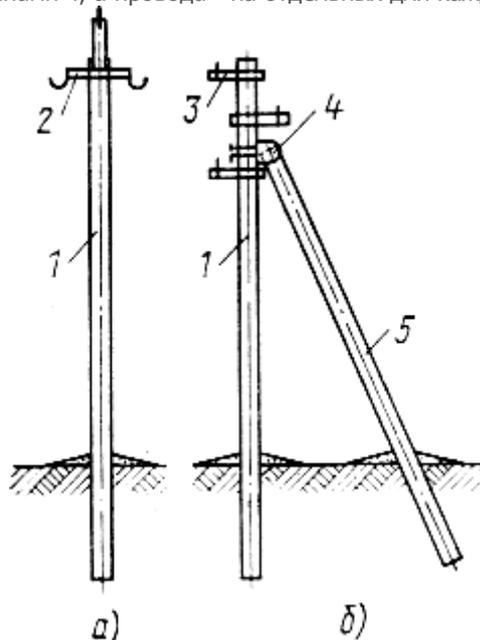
Железобетонные одностоечные опоры ВЛ 6- 10 кВ:
